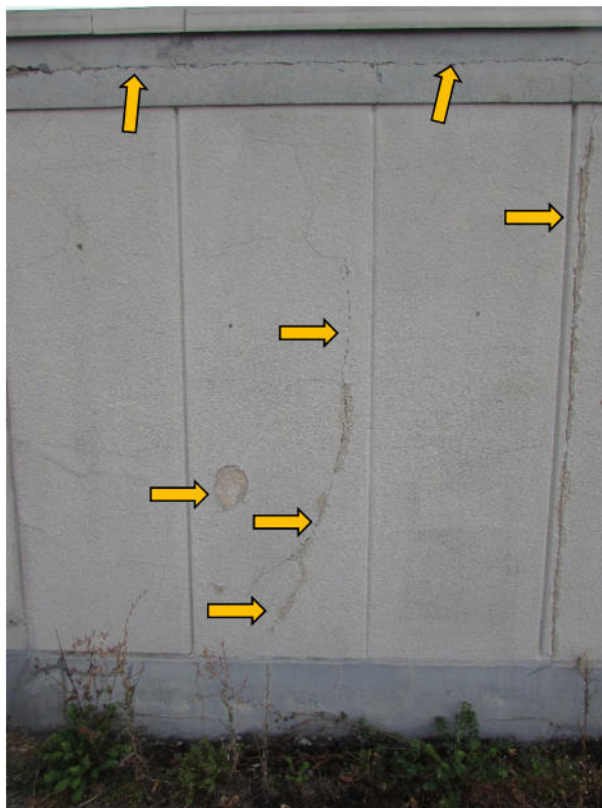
PKW-Fertigarage, Risse und Beschädigungen an der Fassade
